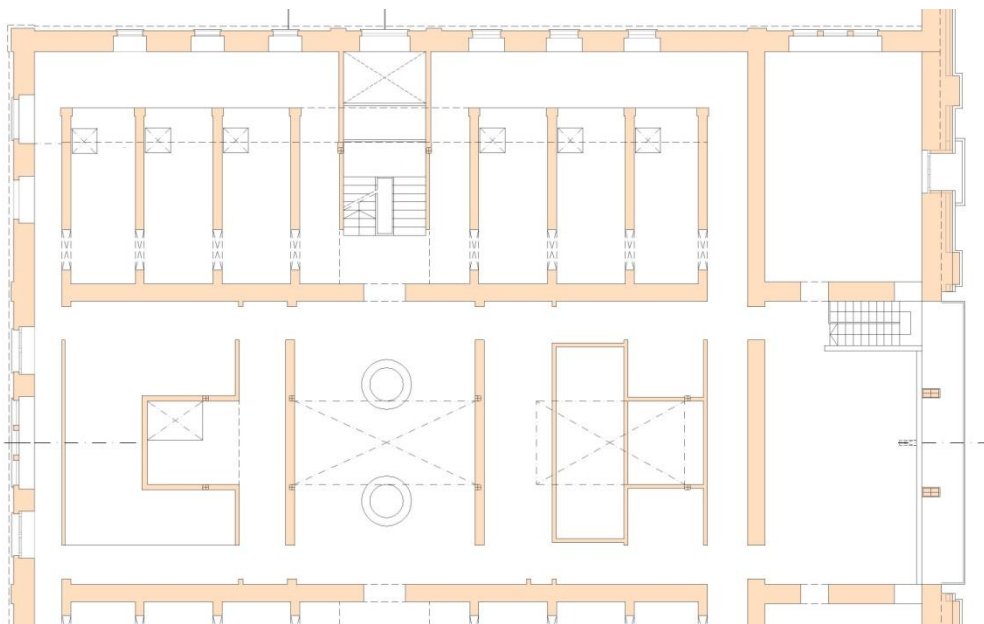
Planta de distribución realmente ejecutada de la Planta Primera.
